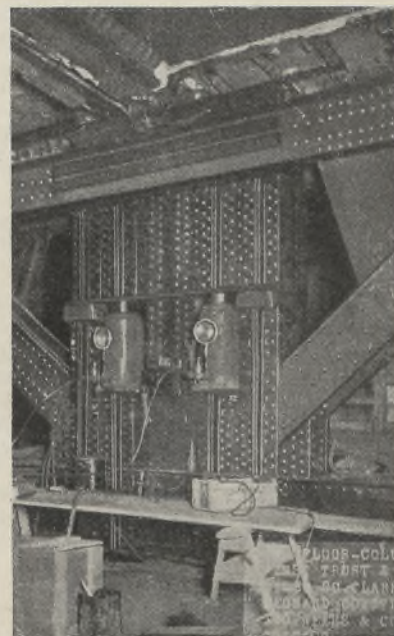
Schwere Stahlfachwerkträger zum Abfangen der von 14 Geschossen auf die Wandstützen zu übertragenden Lasten. (Bemerkenswert die Keile und hydraulischen Winden zur Sicherung der alten Höhenlage bis zum Einbau der neuen Fundamente und Stützen.)
